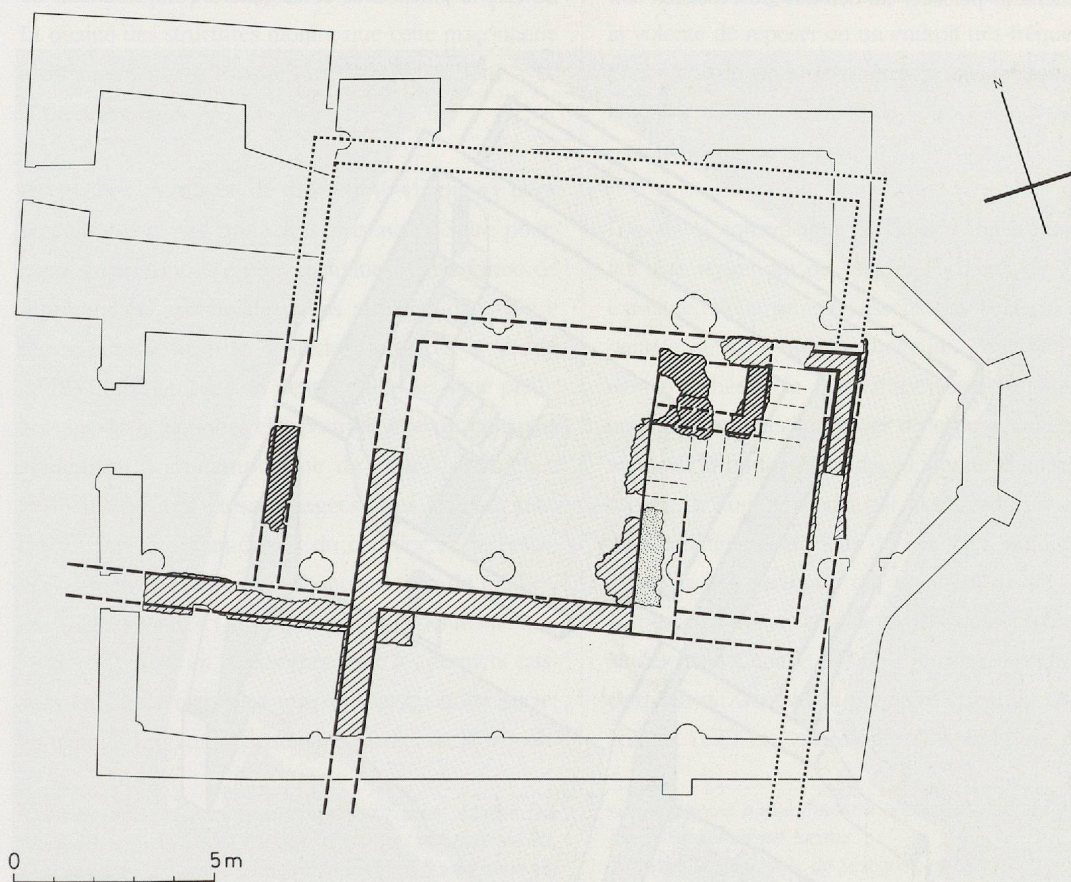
Reconstitution du plan du mausolée transformé. Echelle 1:200
